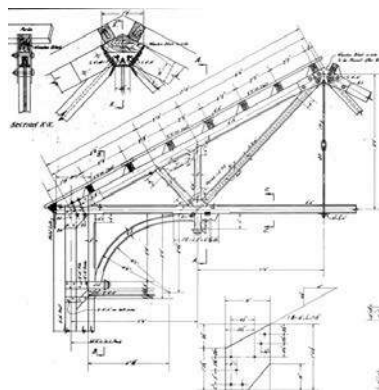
Detalle estructura de techo, planimetría original. Archivo empresa minera SQM
